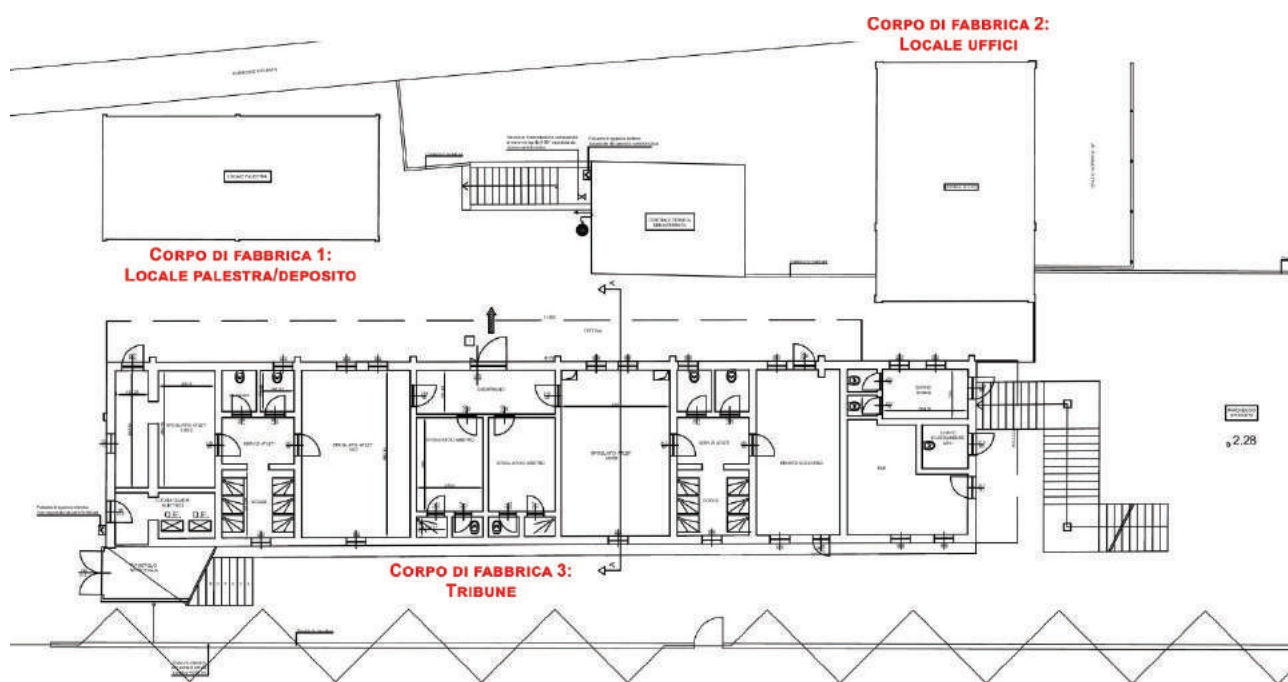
PLANIMETRIA DEL COMPLESSO DEL CAMPO SPORTIVO.
